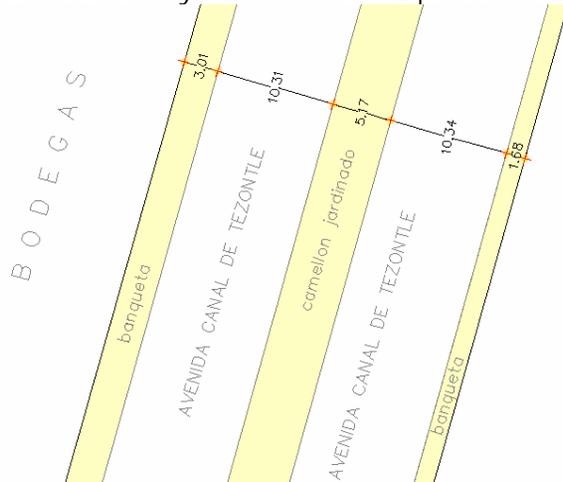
Avenida Canal de Tezontle. Arroyo vehicular De 10.30m, banqueta del terreno 1.68m ancho y banqueta bodegas frente al terreno de 3.00m ancho
